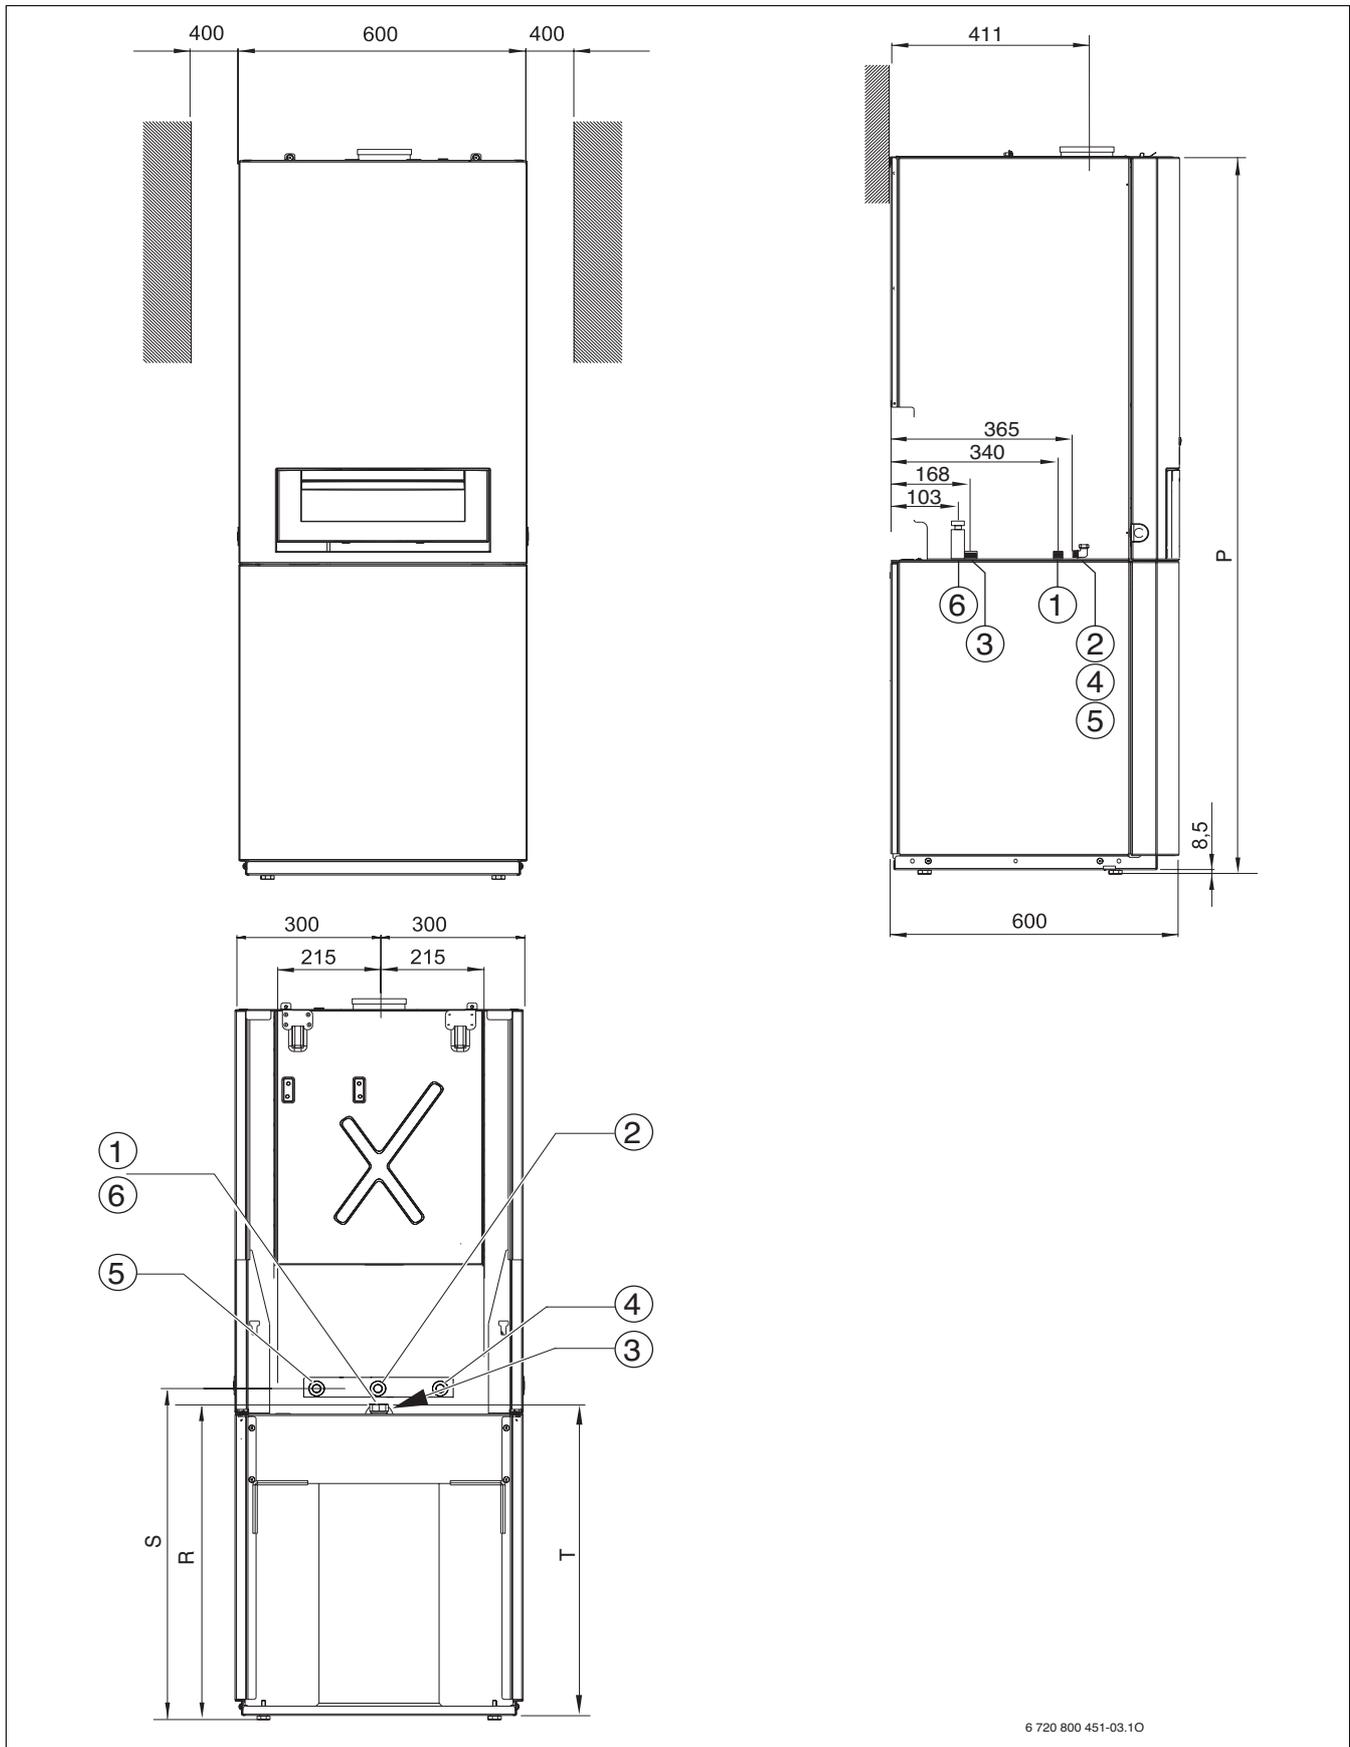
Dimensioni e attacchi per GB172-.. T150S (misure in mm)
